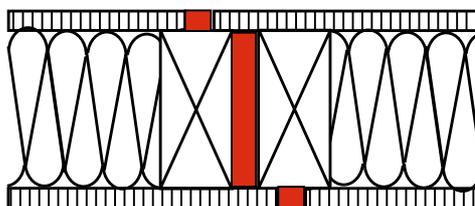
Die Abstände von Deckenelementen ergeben sich erst auf der Baustelle.
